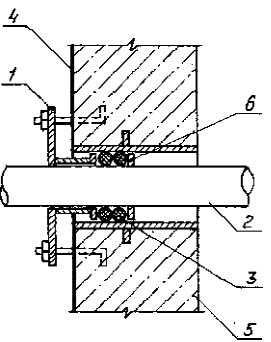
Пропуск трубопровода через гидроизоляцию с прижимным сальником:
